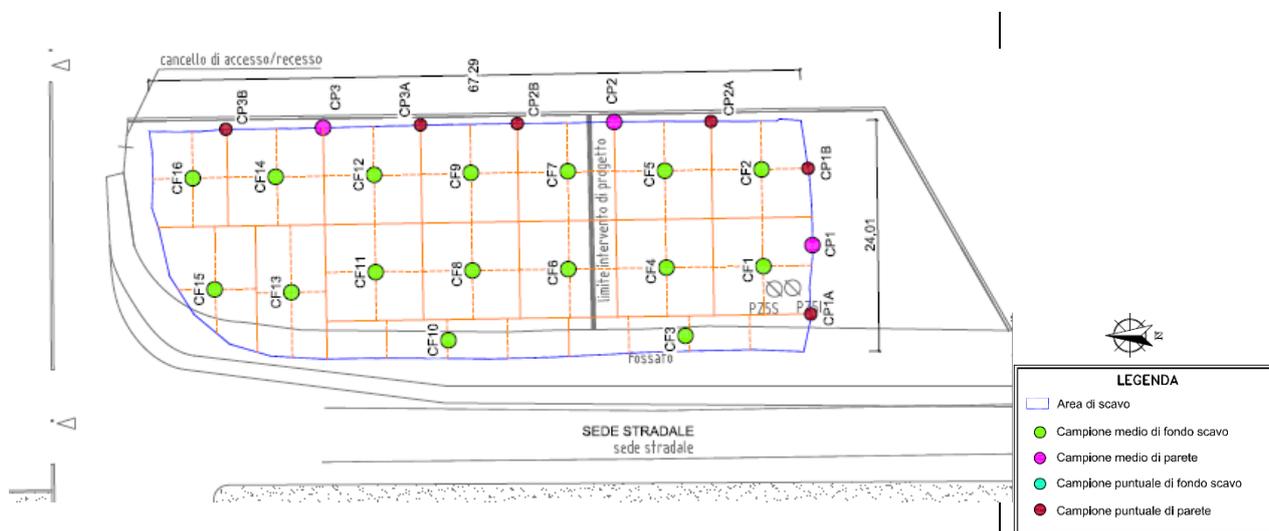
Stralcio “Tavola Collaudo Area di Scavo, campioni prelevati 08/10/15”. (v. Doc. 11)
